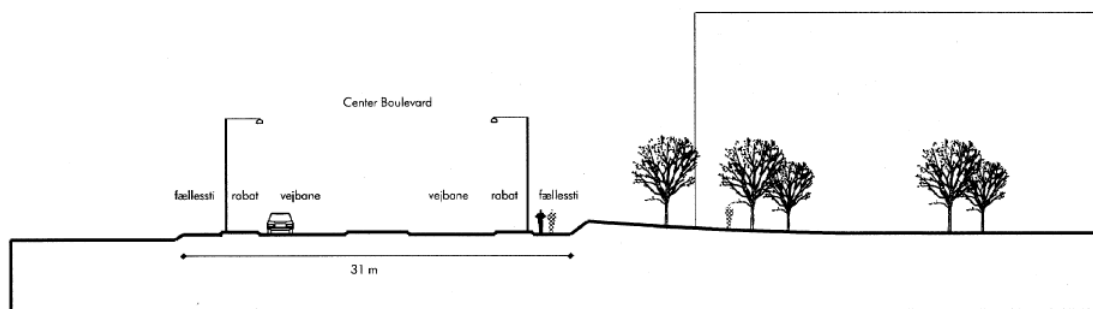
Sección de Center Boulevard, con calzadas separadas. Plan Local Ørestad City, (www.orestad.dk, [41])
